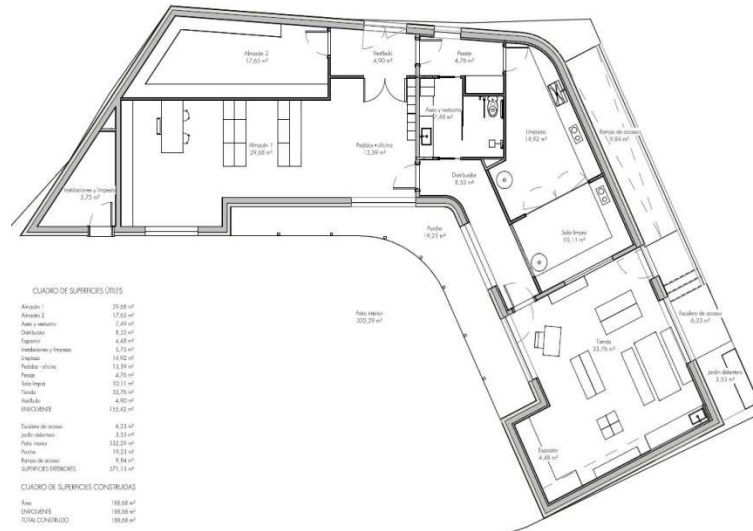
Planta del proyecto piloto. Fuente: Autoría propia, 2021.
